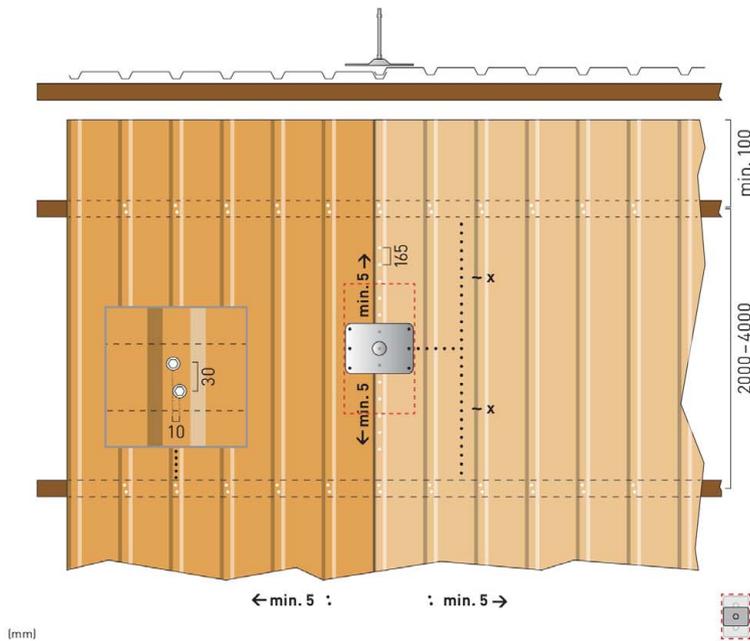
Anschlagereinrichtung PT+ auf Stahltrapezprofil in Positivlage (Tragschale)
